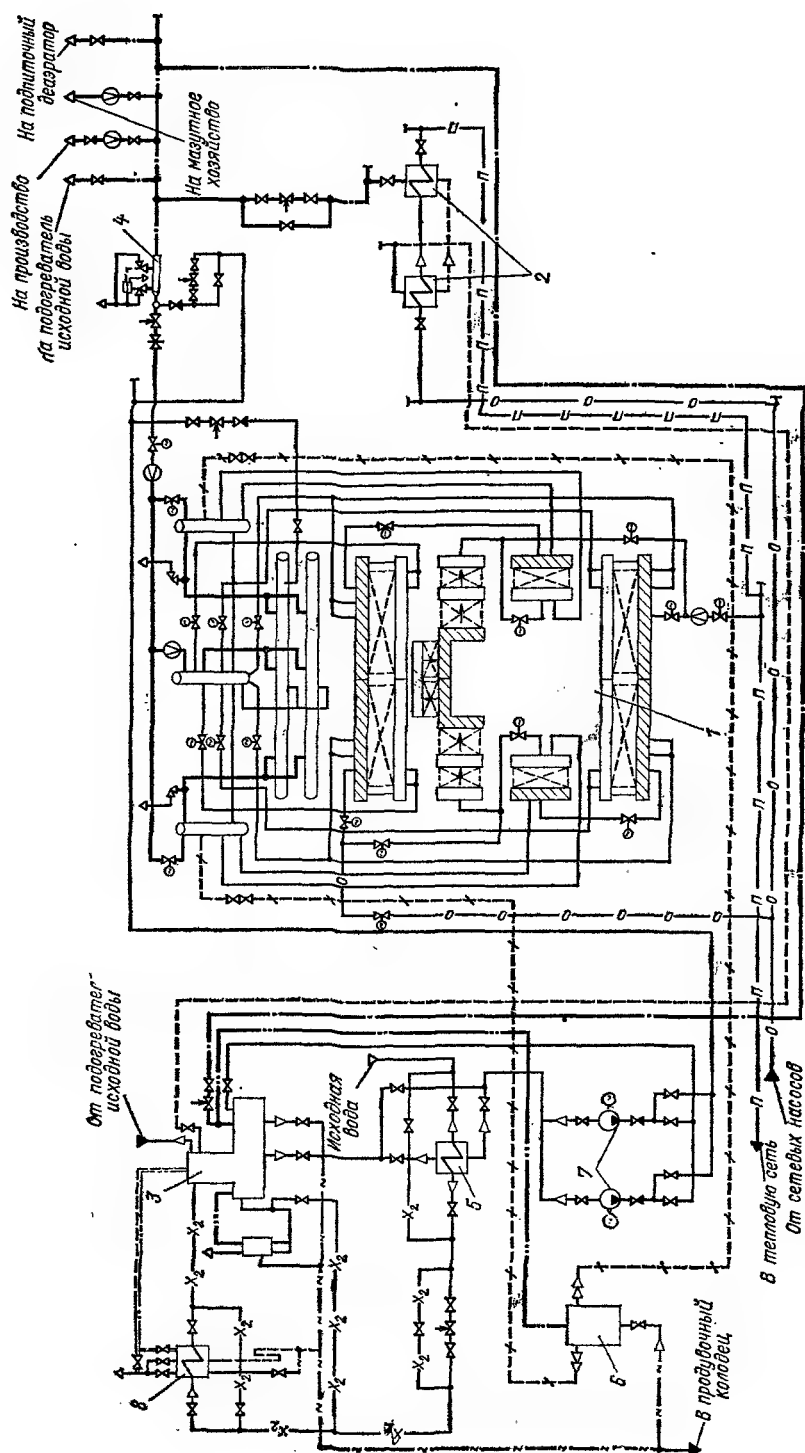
Тепловая схема котельной с пароводогрейными котлами КВП-30/8.
